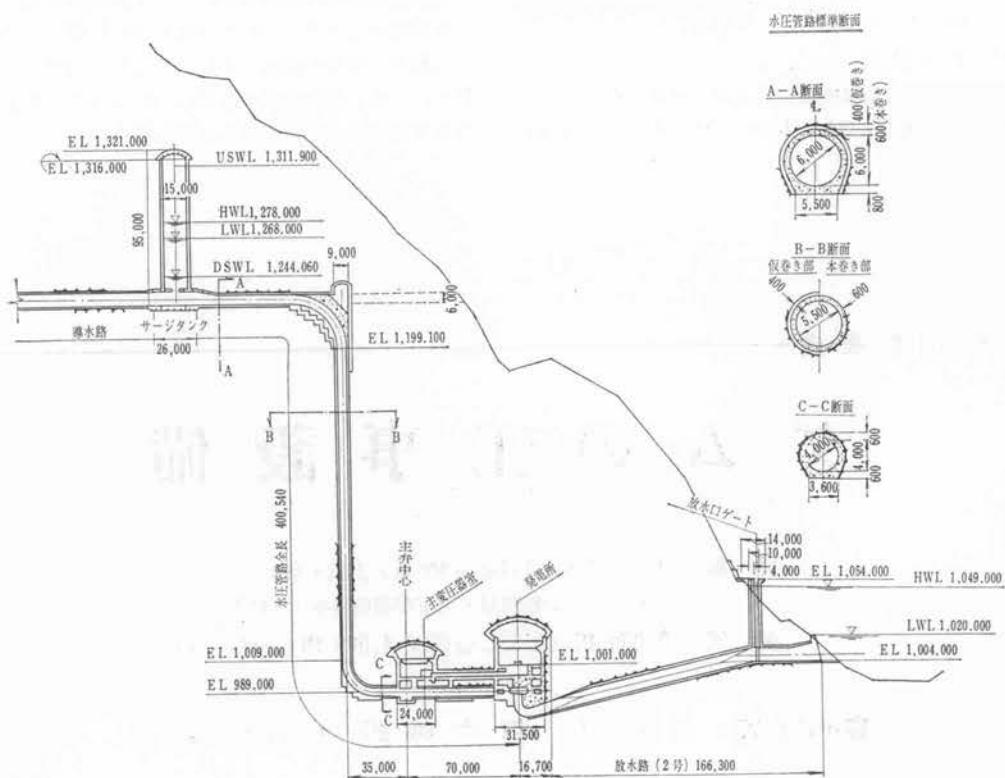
サージタンク, 水圧管路, 発電所, 放水路縦断面図および水圧管路断面図
